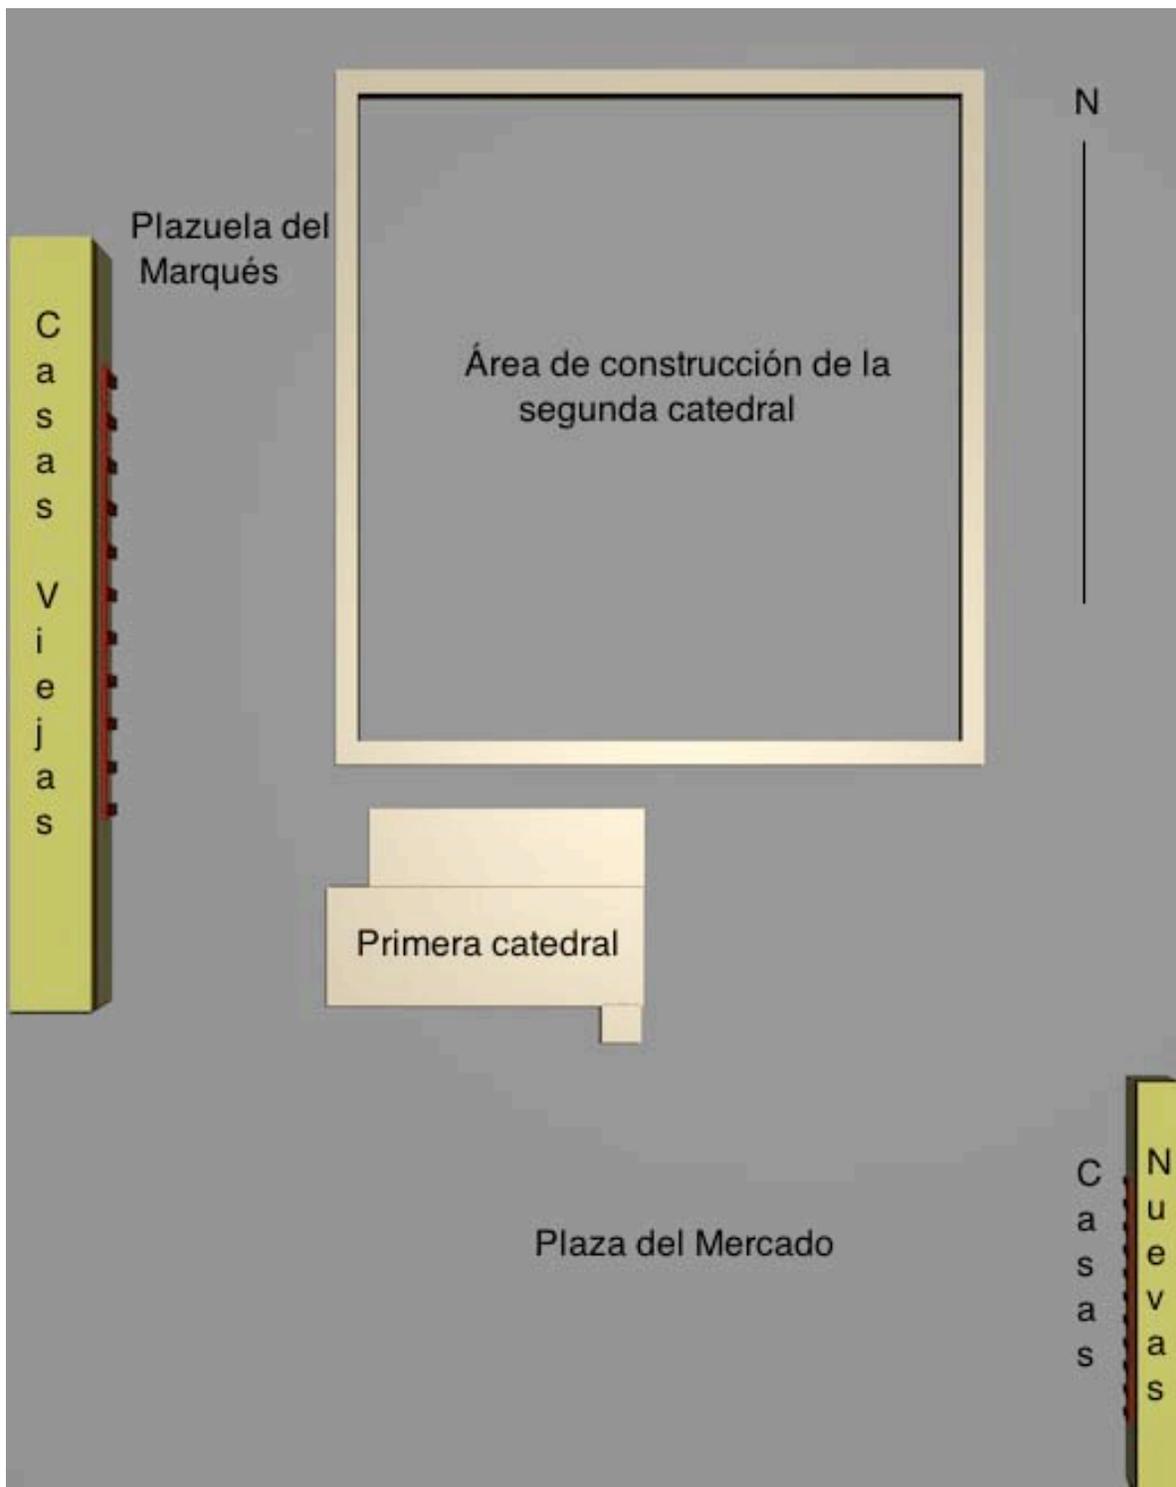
Planta de la primera etapa constructiva. Elaboró Luis Huitron.
